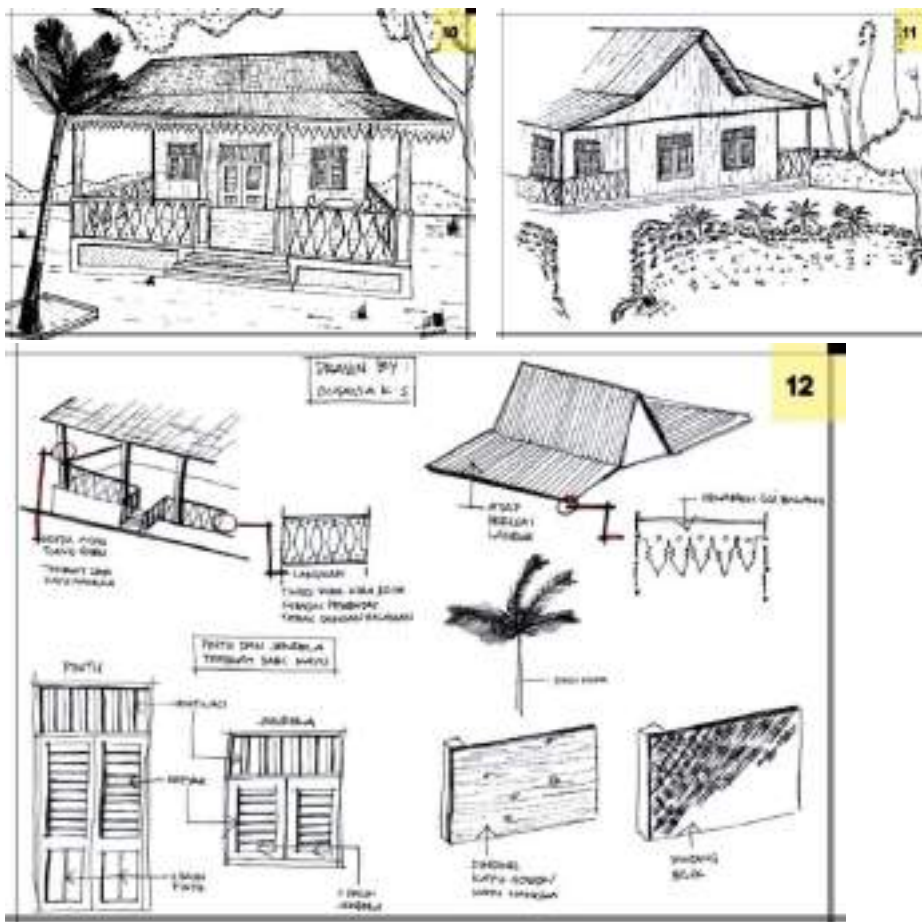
Denah dan bentuk rumah Gudang Betawi
